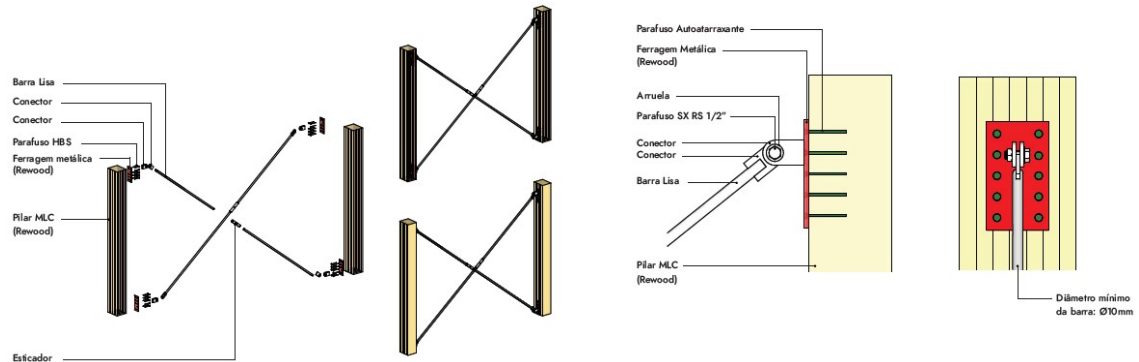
Fixação de estrutura de madeira viga e pilar.
